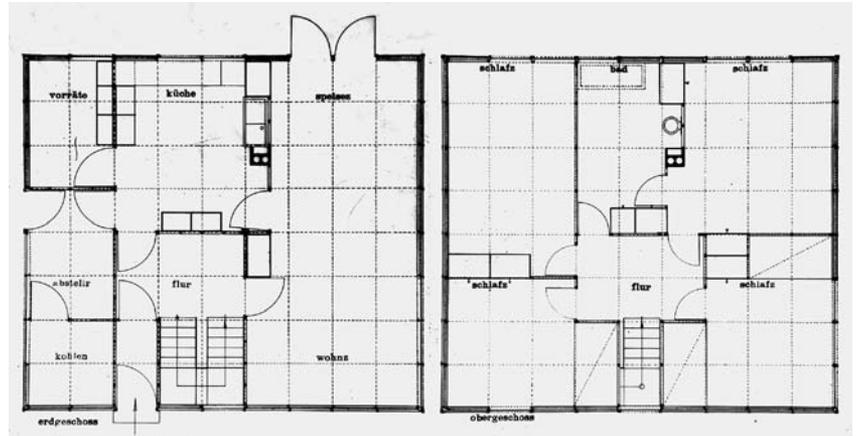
DERECHA, PLANTA BAJA Y PLANTA PRIMERA DE LA VIVIENDA 16 DE WALTER GROPIUS EN LA WEIßENHOSIEDLUNG PUBLICADAS EN BAU UND WOHNUNG. DERECHA, PLANTA SÓTANO Y PLANTA BAJA CON MODULACIÓN, ARCHIVO DE LA CIUDAD DE STUTTGART, 1927.
